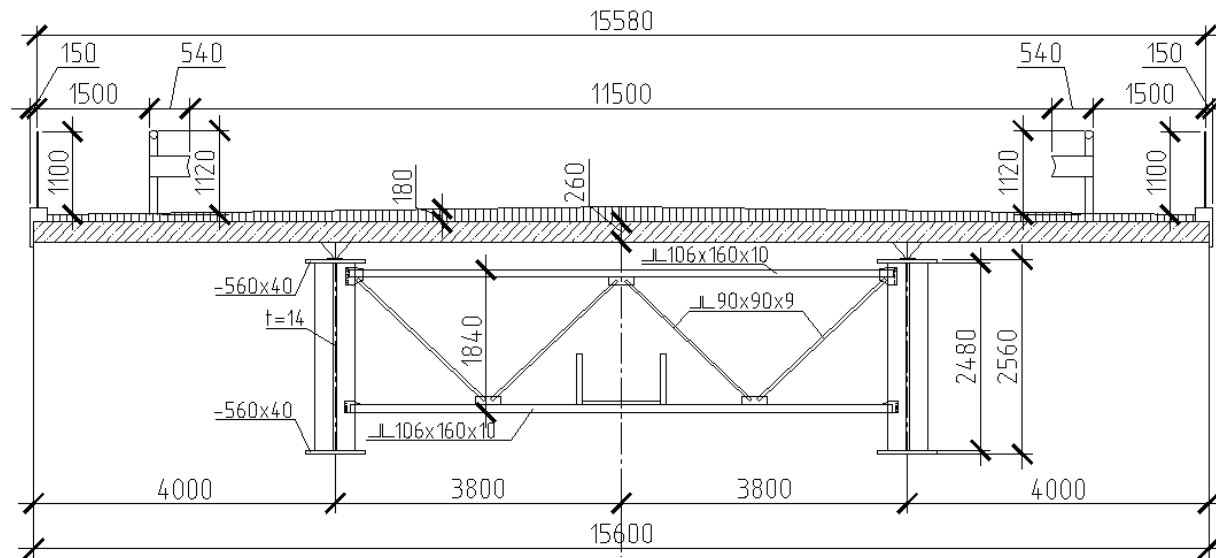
Поперечное сечение сталежелезобетонного пролётного строения на расстоянии 1/4 пролёта в первом пролёте
